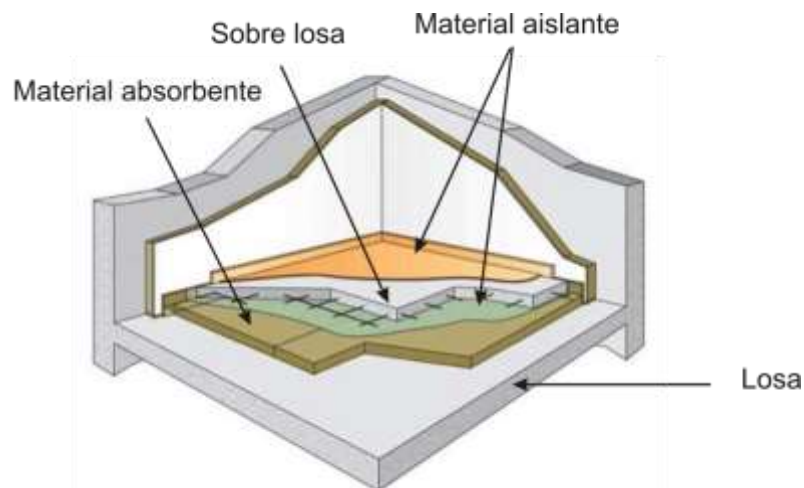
Construcción de un piso con material absorbente y aislante acústico.
